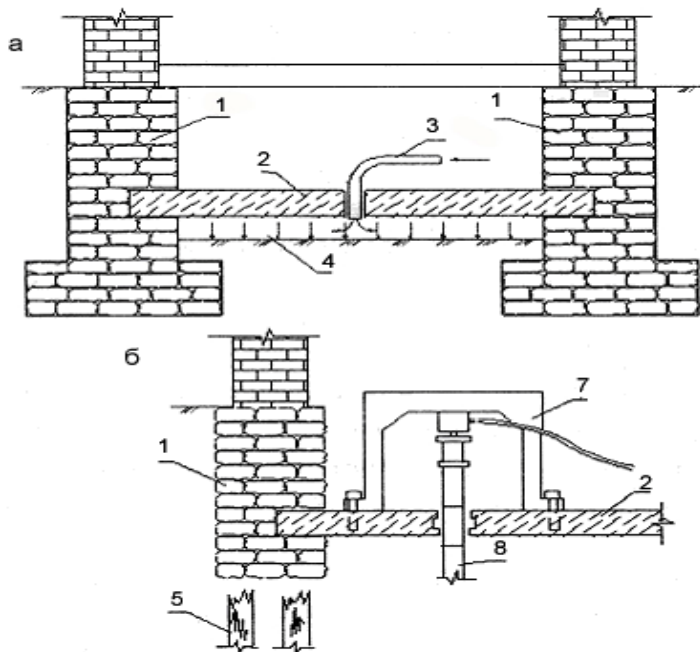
Збільшення опорної площі за допомогою монолітної залізобетонної плити: а – з обпресуванням ґрунту; б – з підведенням багатосекційних палів вдавлювання; 1 – існуючий фундамент; 2 – залізобетонна плита; 3 – труба для ін’єкції розширювального цементного розчину; 4 – цементний розчин між плитою та ґрунтом; 5 – згнилі дерев’яні палі; 6 – домкрат; 7 – опорне коромисло; 8 – вдавлювані палі
